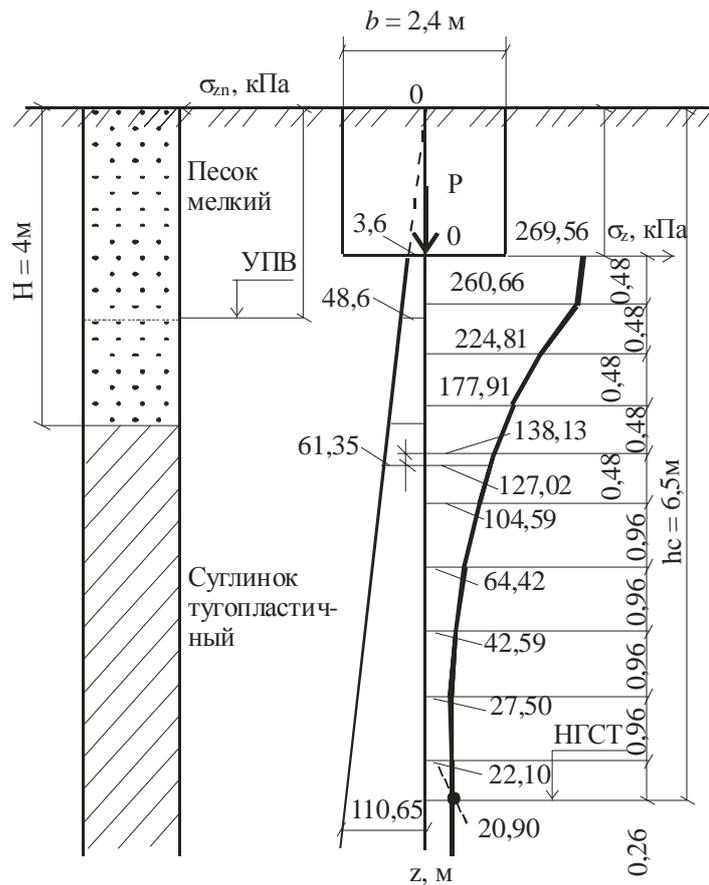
Схема для расчета осадка фундамента методом послойного суммирования
